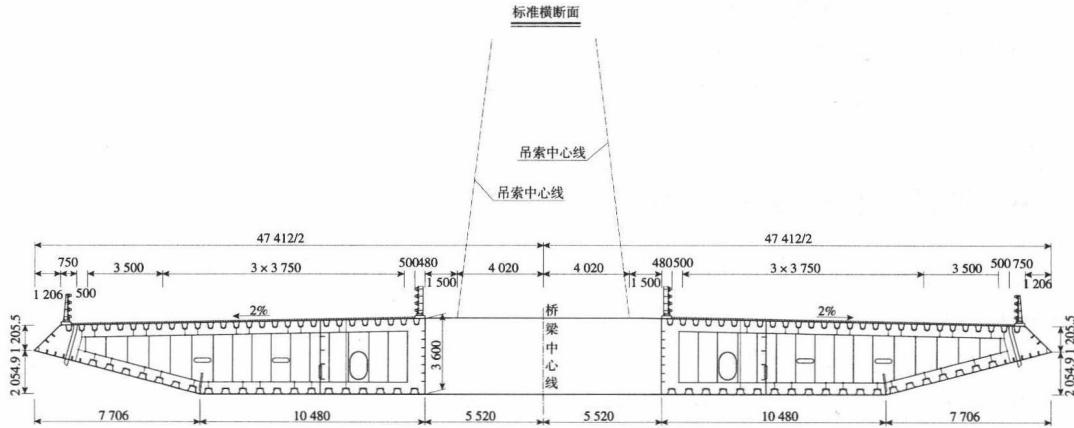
大沽河航道桥加劲梁标准横断面(尺寸单位:mm)
